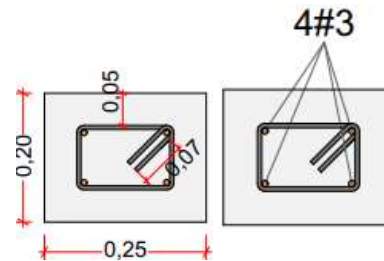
SECCIÓN DE VIGA TIPO DE CIMENTACIÓN. FUENTE: AutoCAD elaboración propia.
